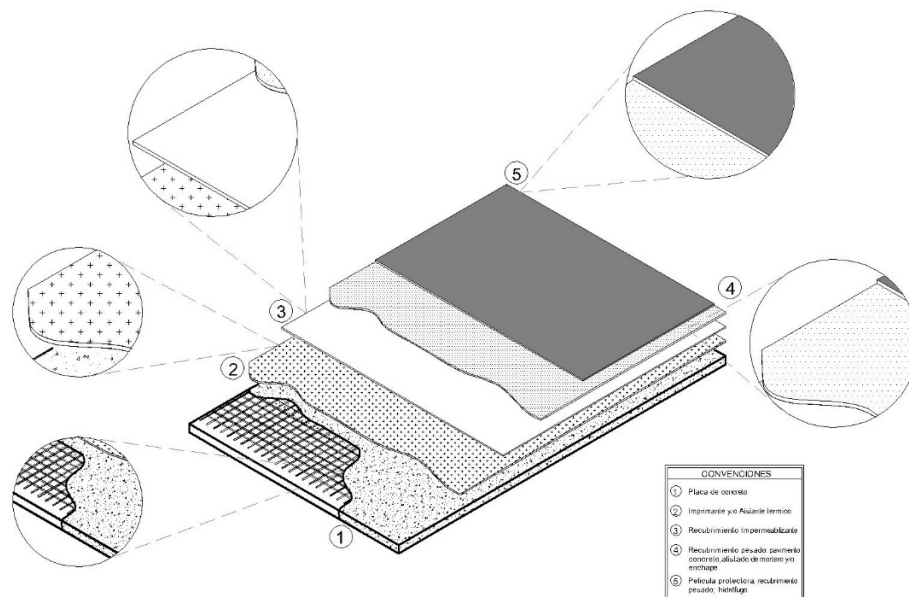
Estructura en la tipología de impermeabilización de cubiertas planas en concreto reforzado del modelo (elaboración Propia)
